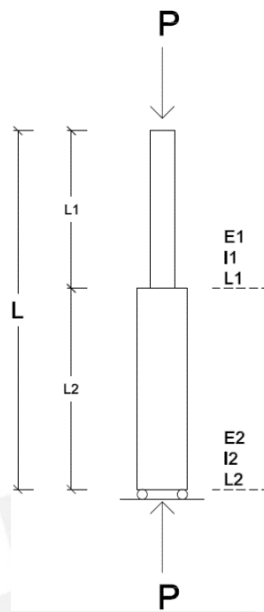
Columna de sección compuesta. Apoyos móvil-articulado.
